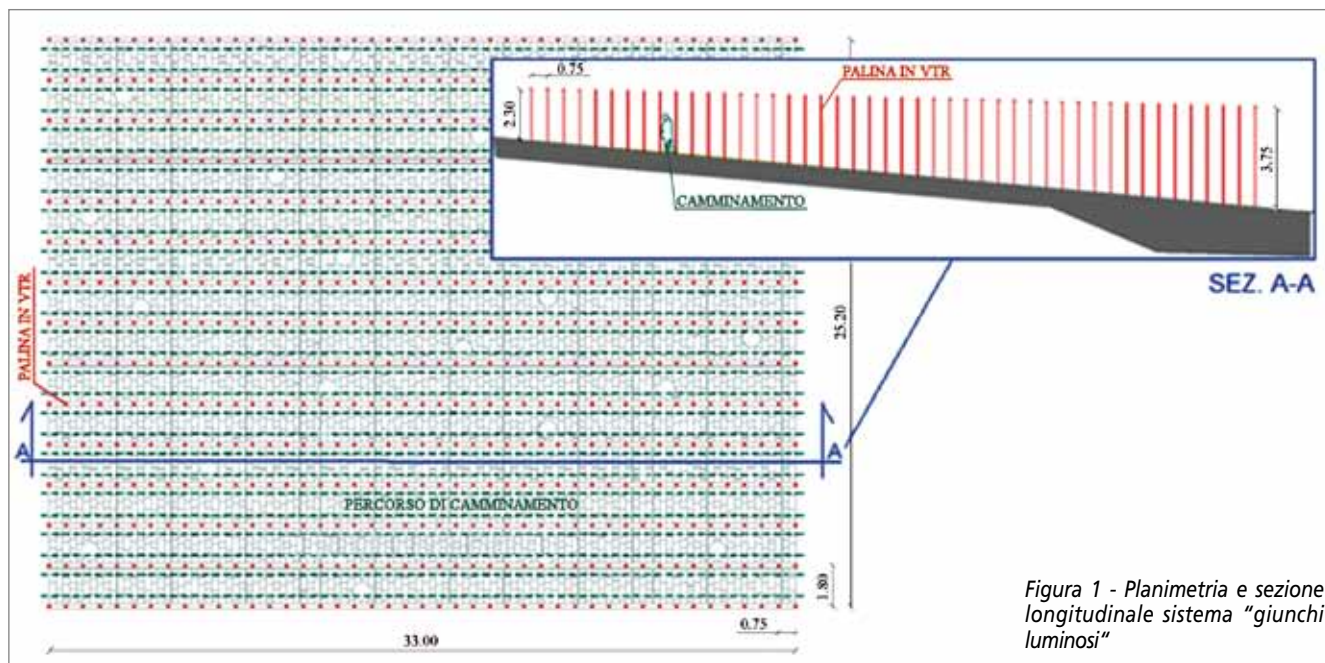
Planimetria e sezione longitudinale sistema "giunchi luminosi"
